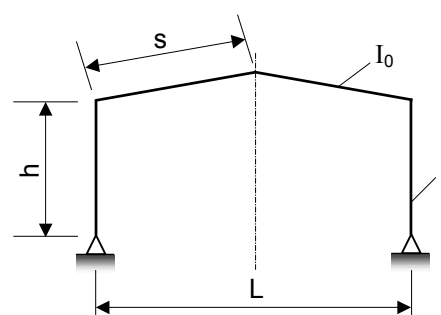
Pórtico. Fonte: DIN 1052/88
